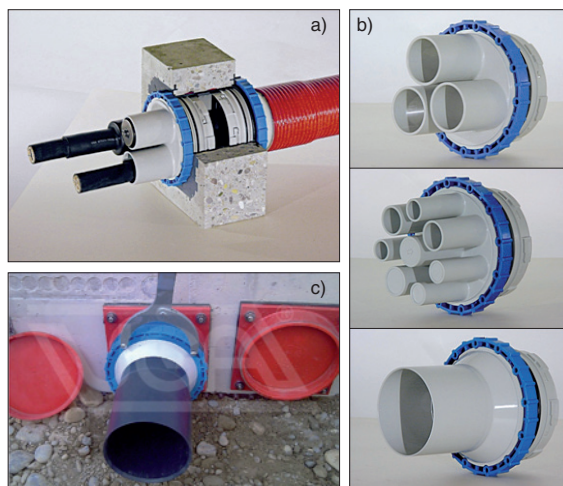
Skupina pažnice a) připraveno k zalití betonem, b) po zabetonování
